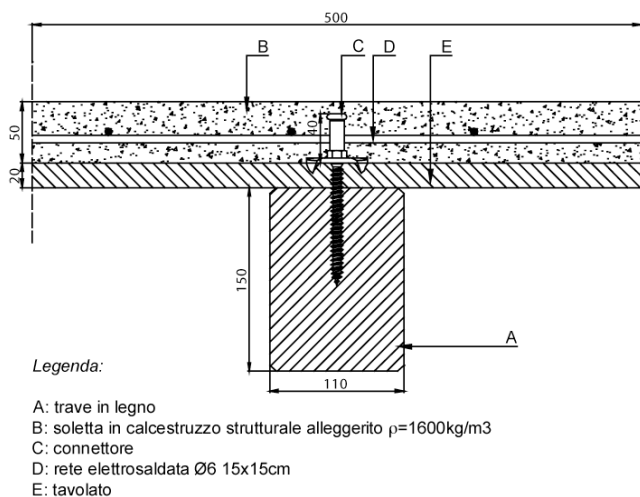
Sezione del travetto tipo misto in legno-calcestruzzo.
